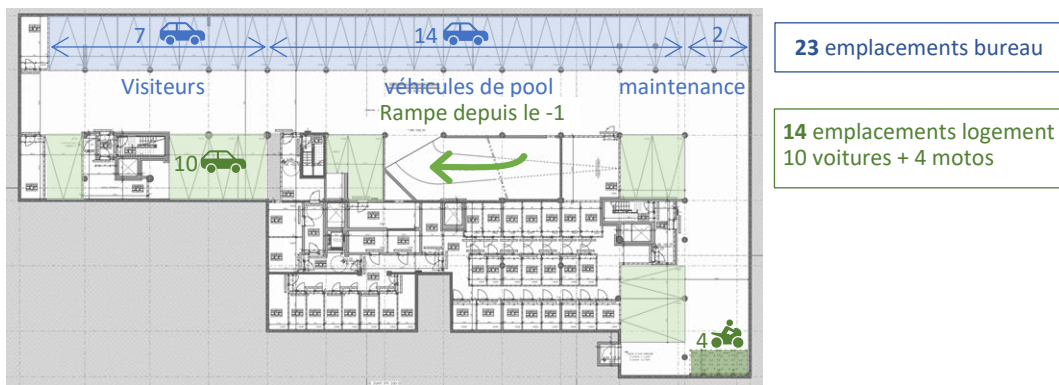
sous-sol -2 sous le bâtiment B. reprenant l'implantation des places « bureau » telles qu'autorisées dans le PEM2.
